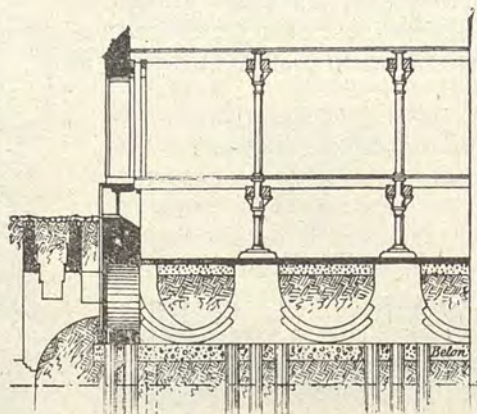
Fondazione a pilastri ed archi rovesci sopra palificate.
